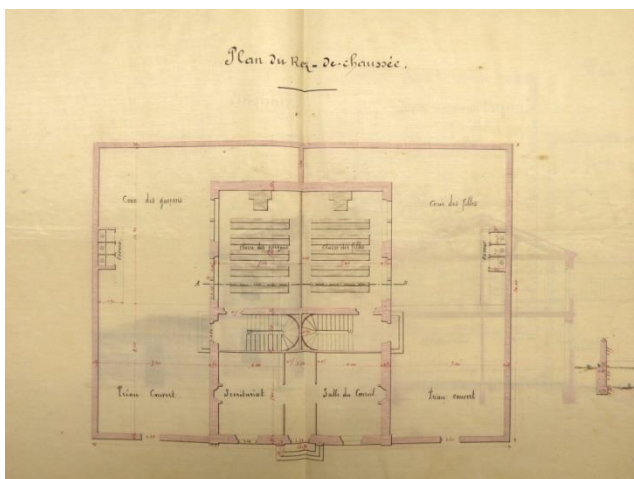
Projet de construction d'une mairie avec maison d'école, plan du rez-de-chaussée, Verlaque (agent voyer).
